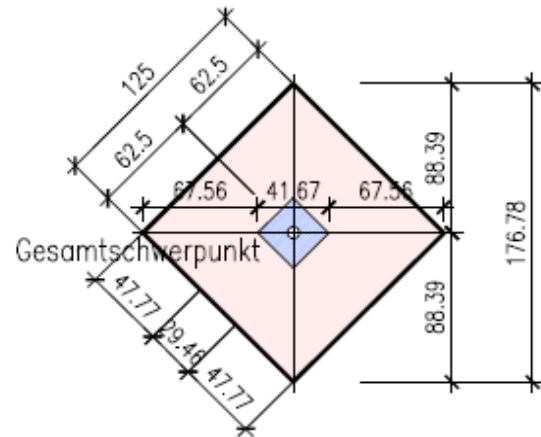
Querschnittsabmessungen für die Pfeiler B und C
